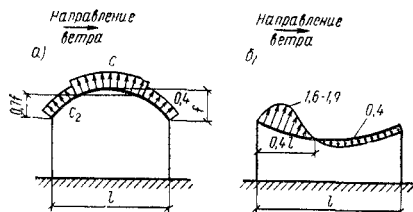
Схемы ветровой нагрузки на покрытия
